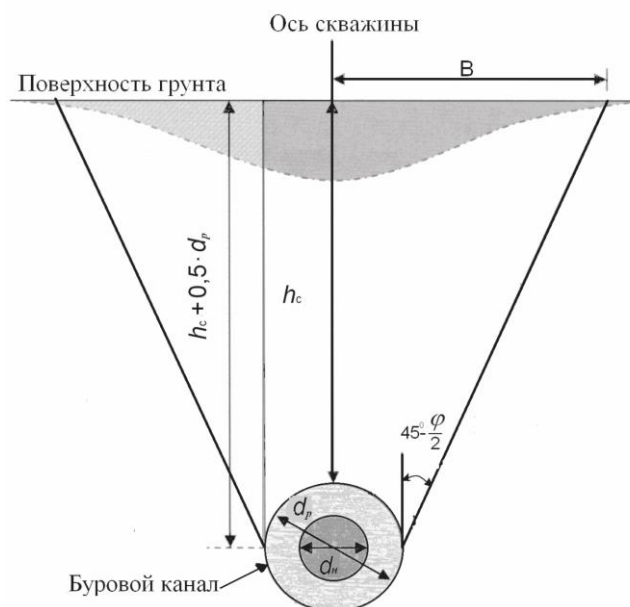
Расчетная схема для определения осадки грунта при осуществлении прокладки трубы методом горизонтального направленного бурения.
